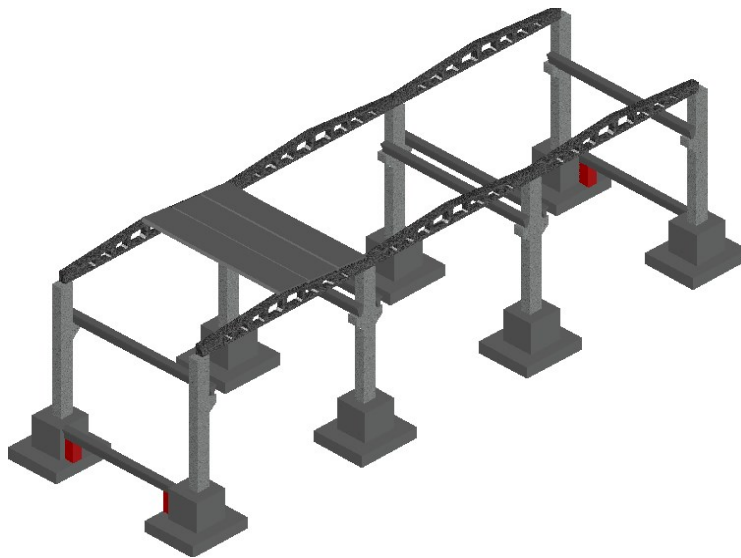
Фрагмент каркаса с балками (подкрановыми и фундаментными) и плитами покрытия
